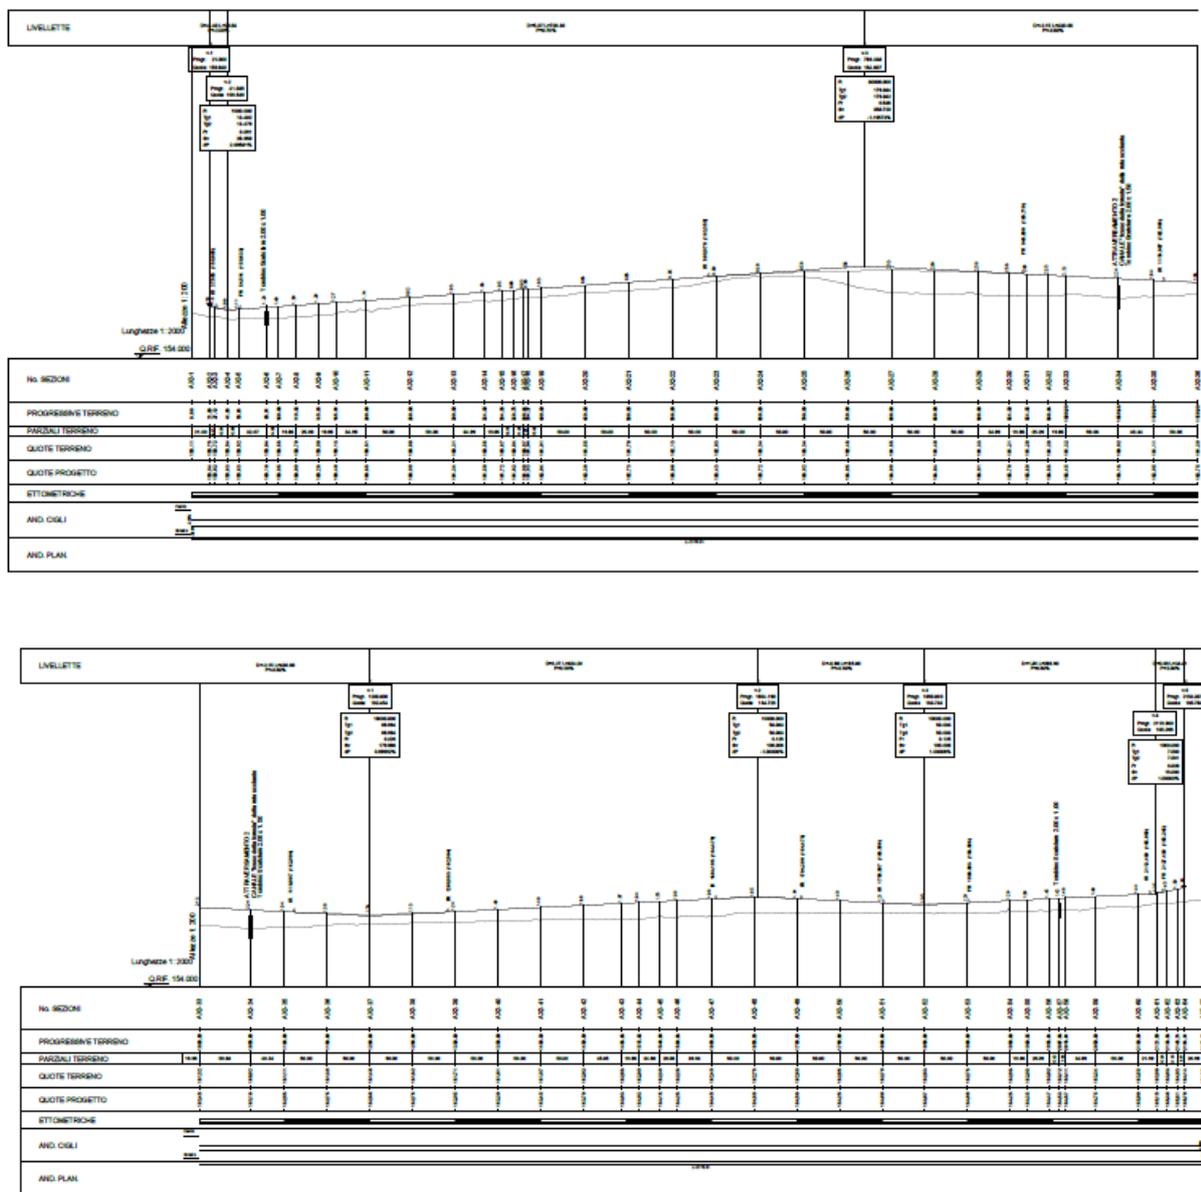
STRALCIO ELAB. 26_T00IA40AMBFP03A - TRATTO ASSE PRINCIPALE 2: PROFILO LONGITUDINALE
